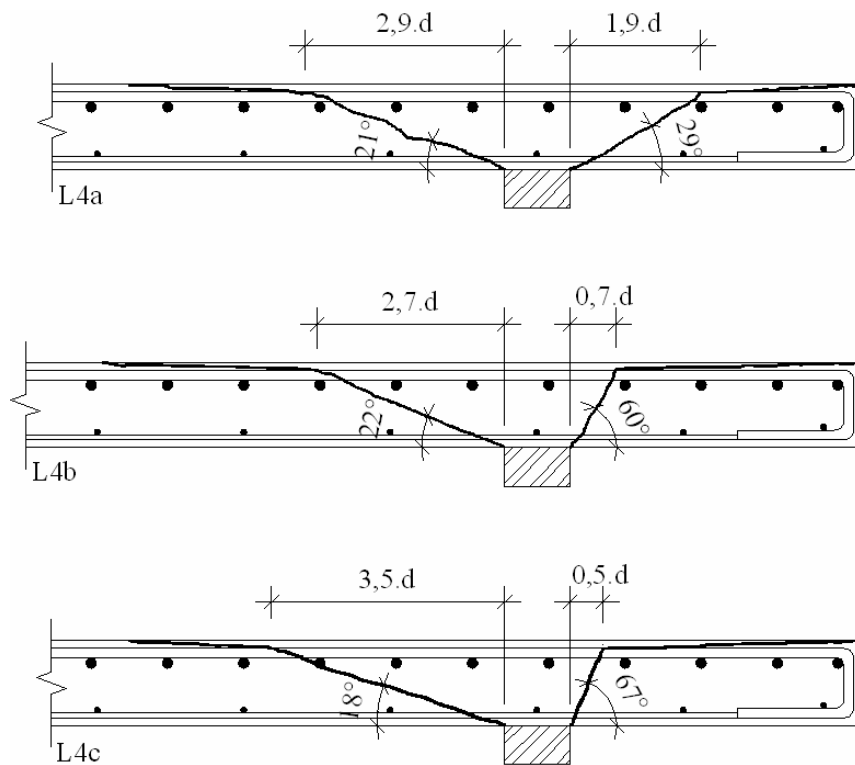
Inclinação do cone de ruptura na direção longitudinal das lajes na posição 4
